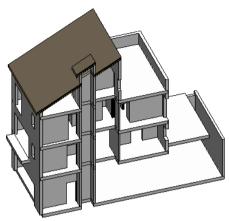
Muros, tabiquería, suelos y cubierta. 2014. Elaboración propia.
